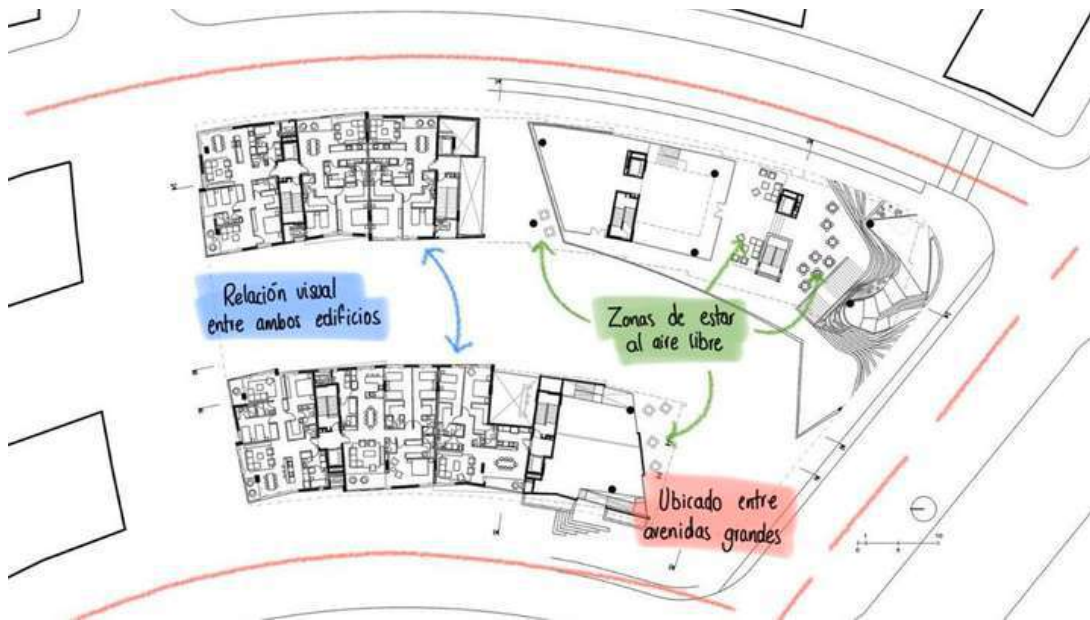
Planta arquitectónica intervenida con zonificación.
